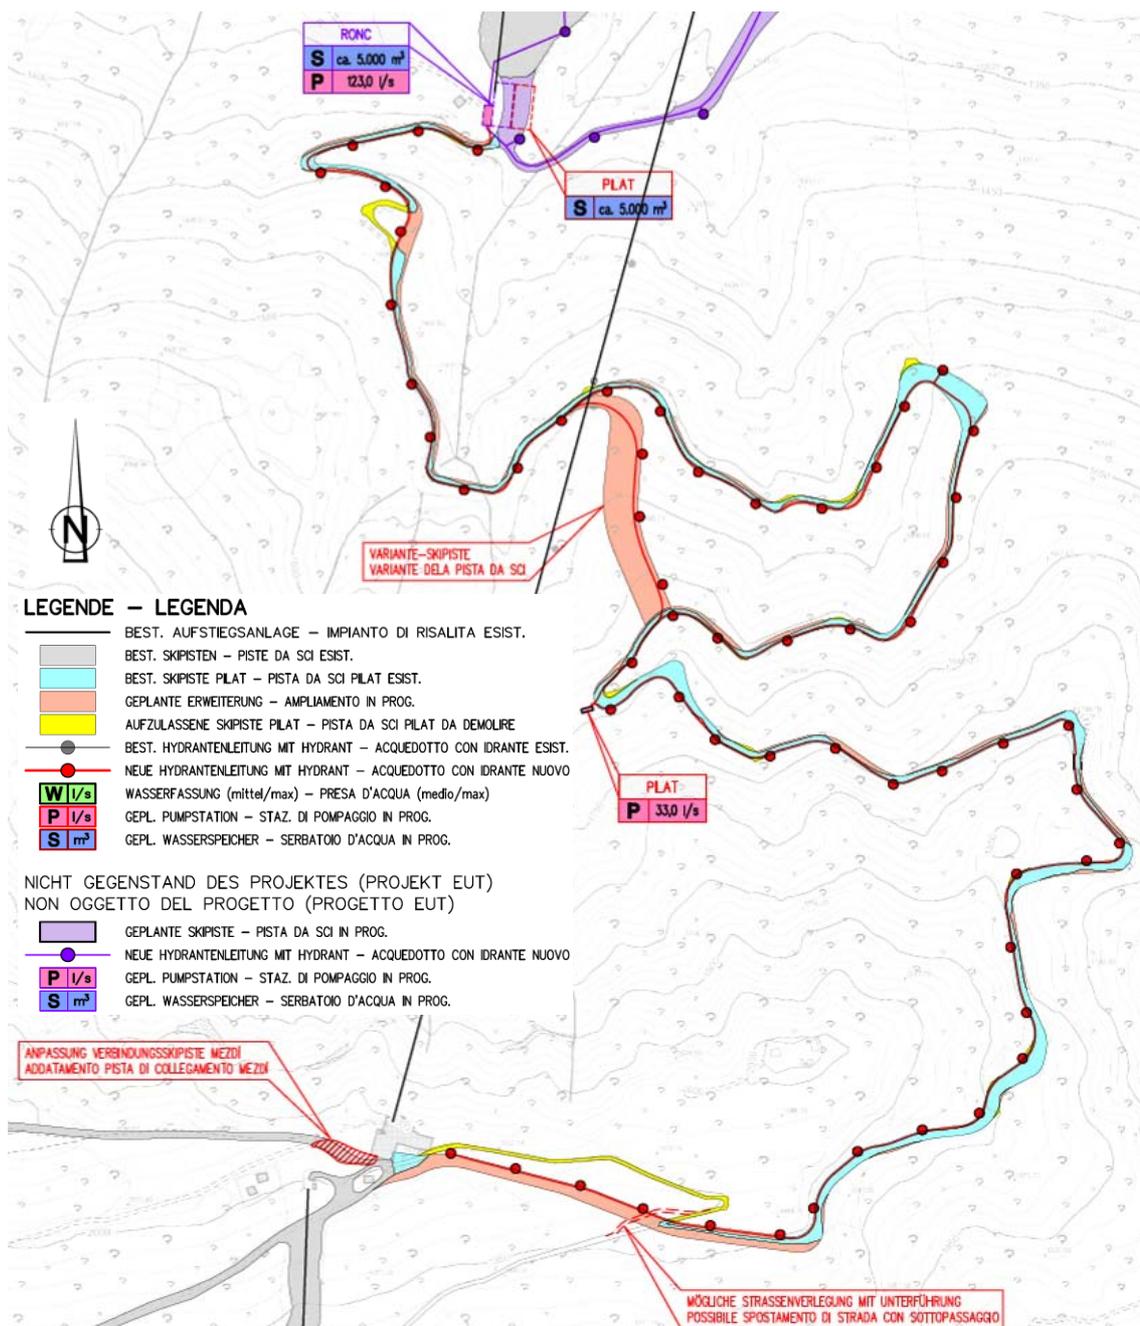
Projekt Sanierung und Ausbau Piste Pilat [2]
